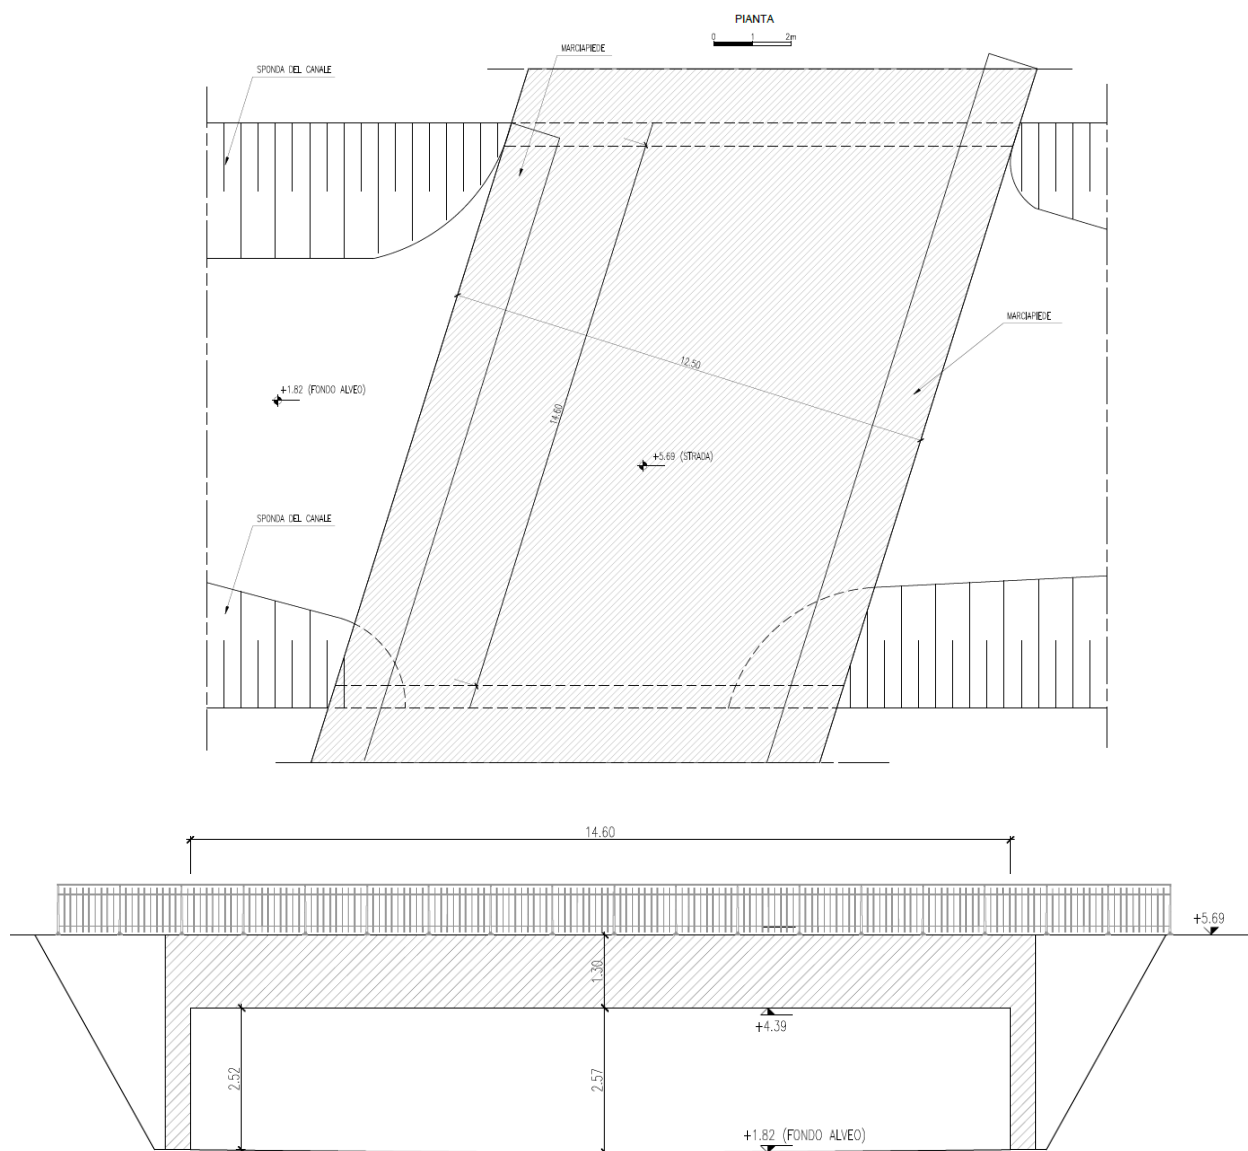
Disegni del rilievo del ponte di via Tre Venezie (sopra: pianta - sotto: sezione)
